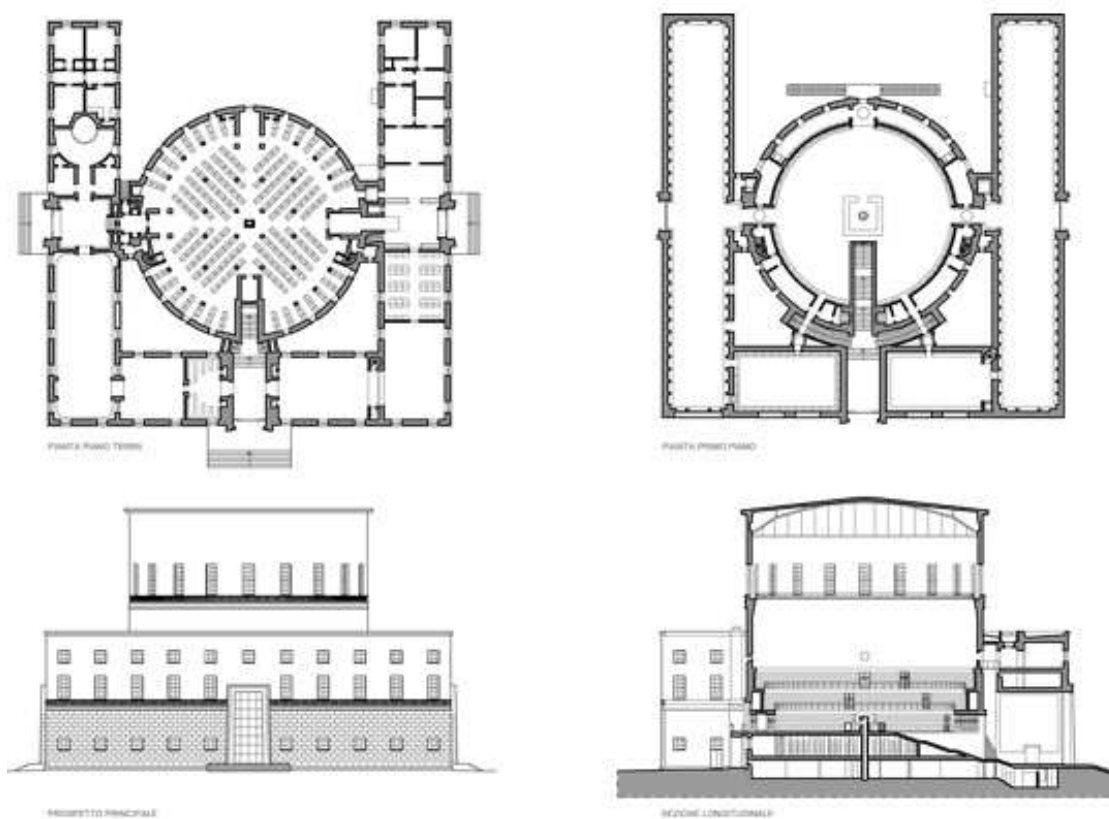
Stadsbibliothek, Stoccolma, architetto Gunnar Asplund, 1935. Pianta del piano terra, del piano primo, prospetto principale e sezione longitudinale.
